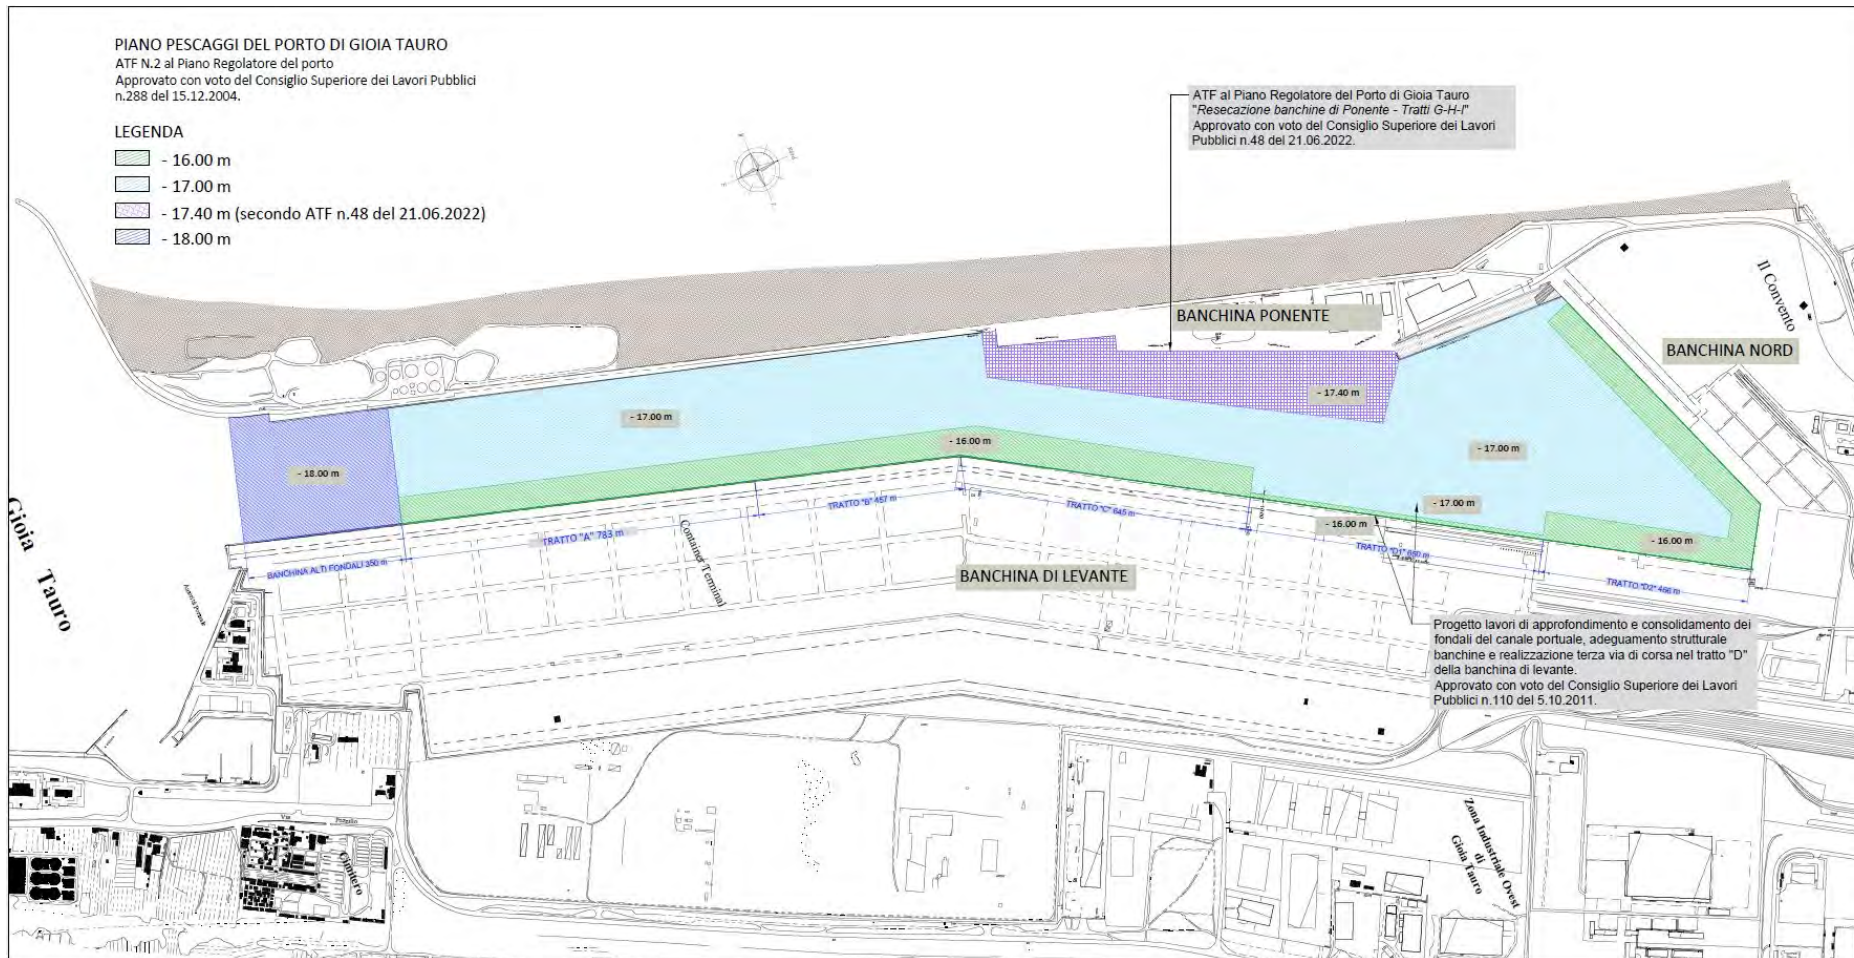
Planimetria stato dei luoghi – Piano pescaggi approvato con voto n.288 del 15.12.2004
